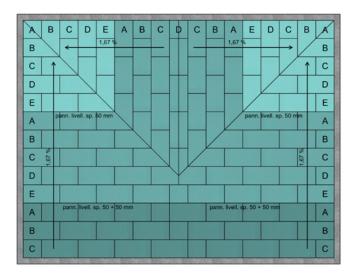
Coppia di drenaggi in corrispondenza degli angoli del parapetto laterale
